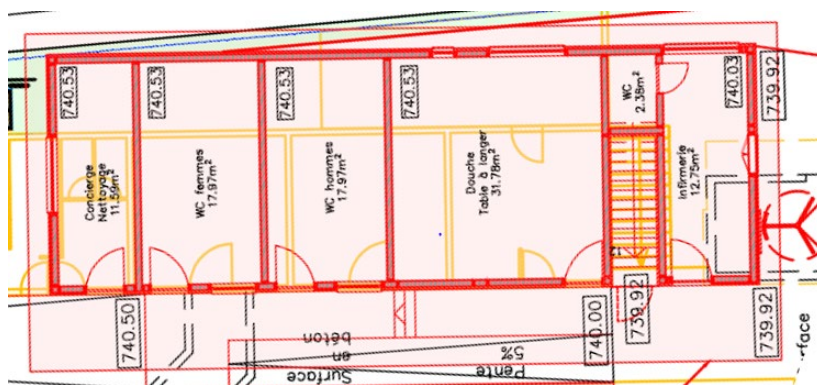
Bâtiment B, rez-de-chaussée supérieur
